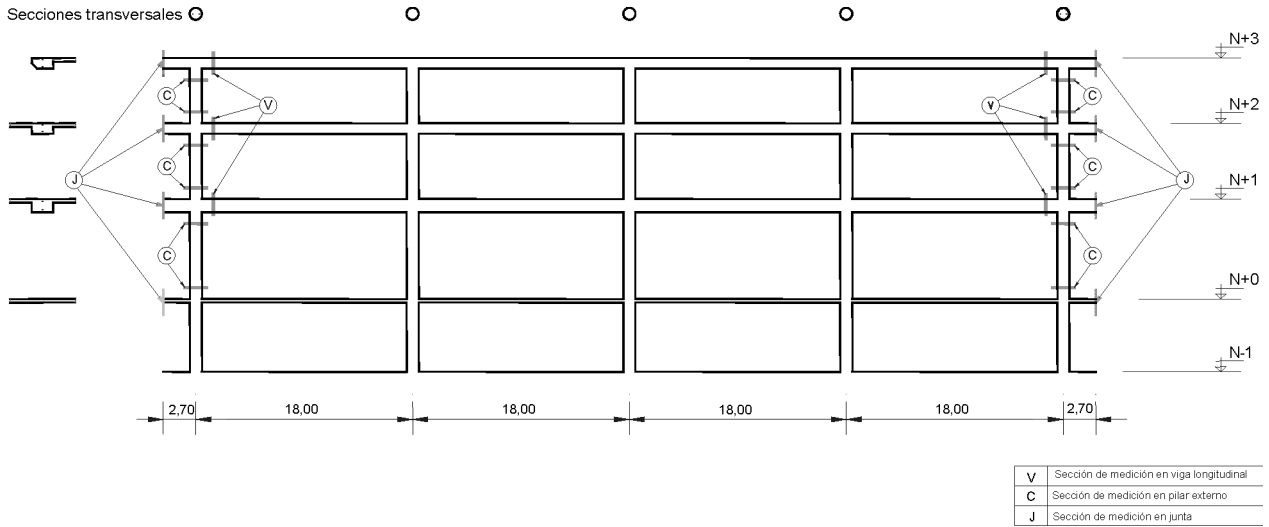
Esquema del pórtico longitudinal y secciones de medición.
